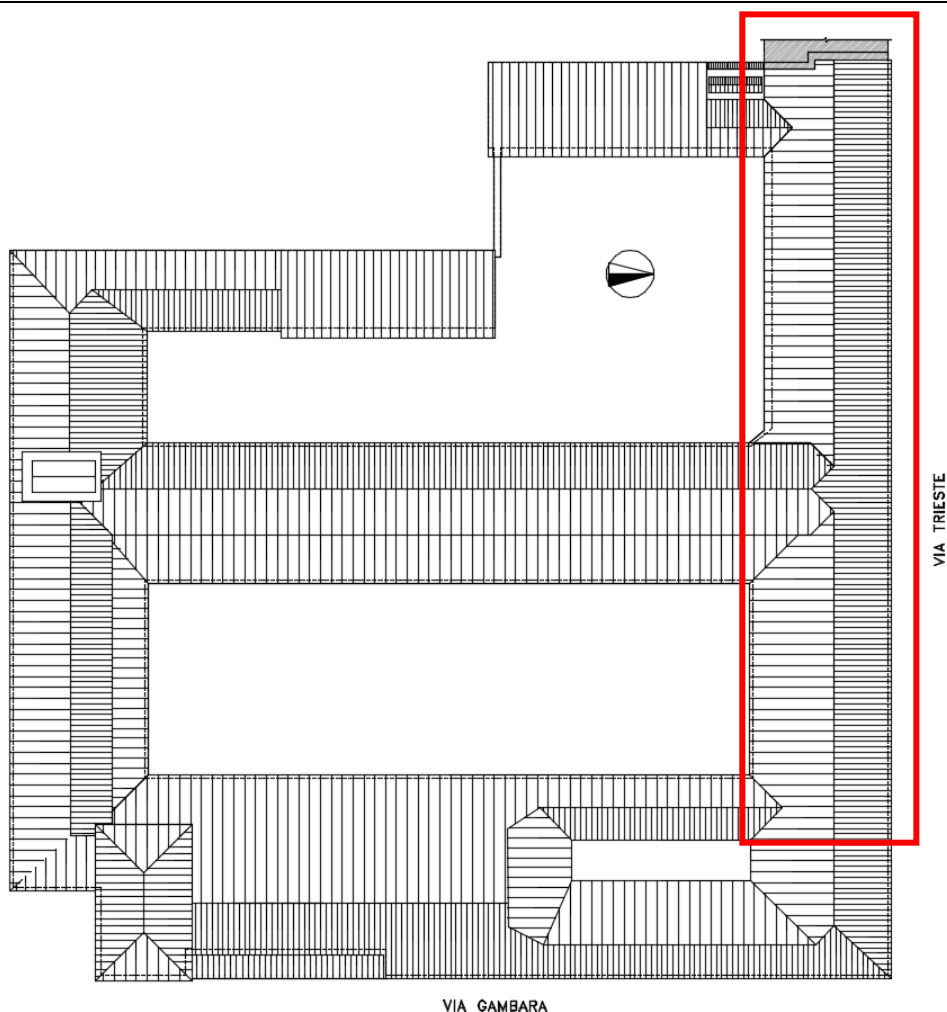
Planimetria del complesso con individuazione della porzione di tetto oggetto di intervento
